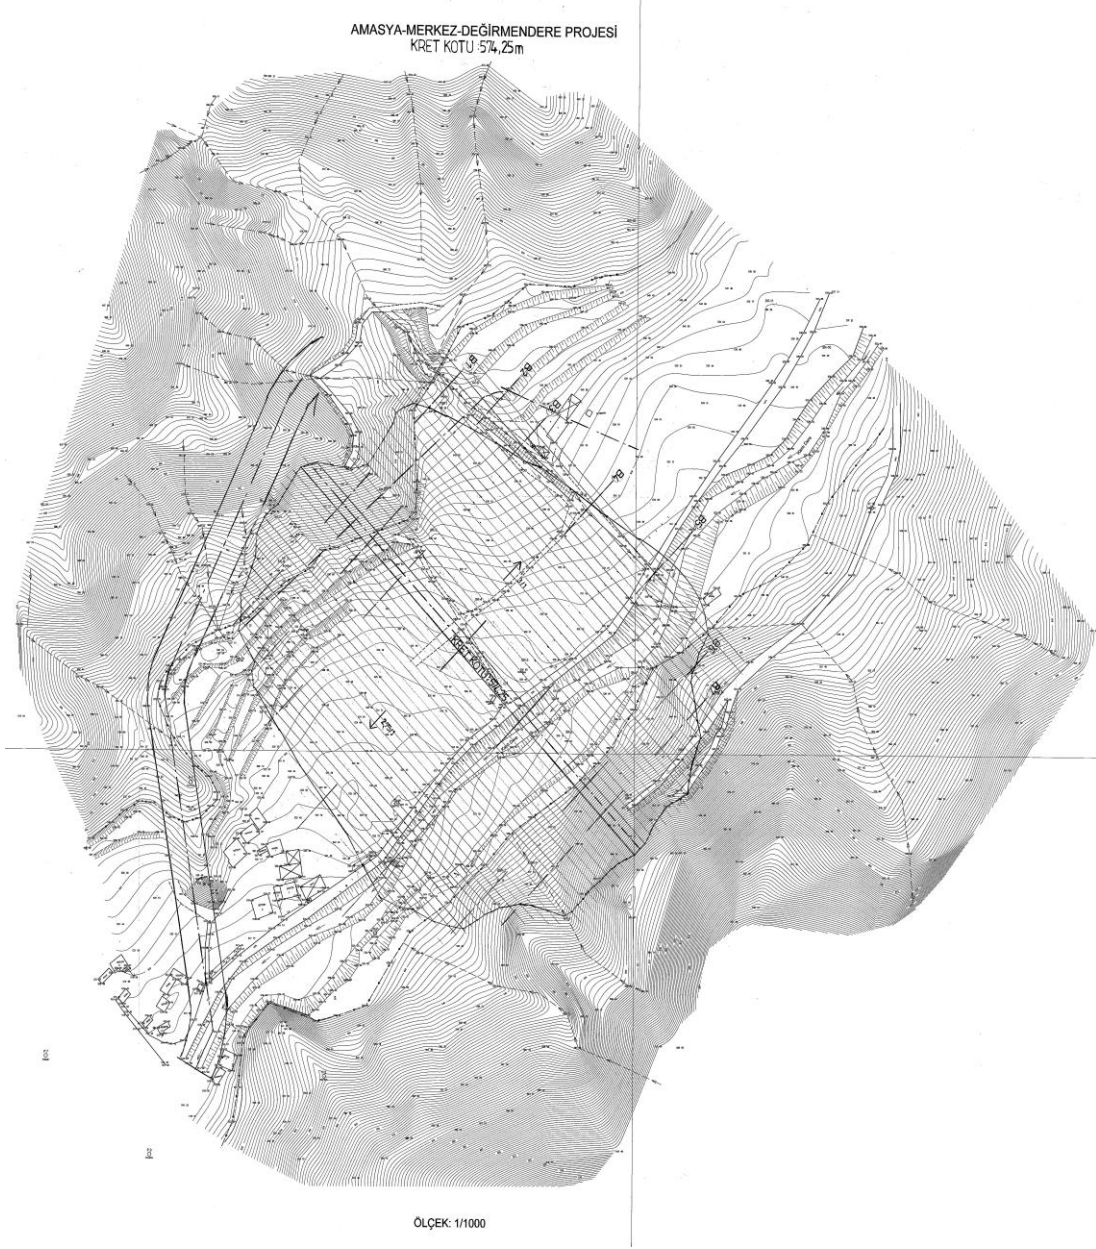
Proje Genel Vaziyet Planı (2. Alternatif)
